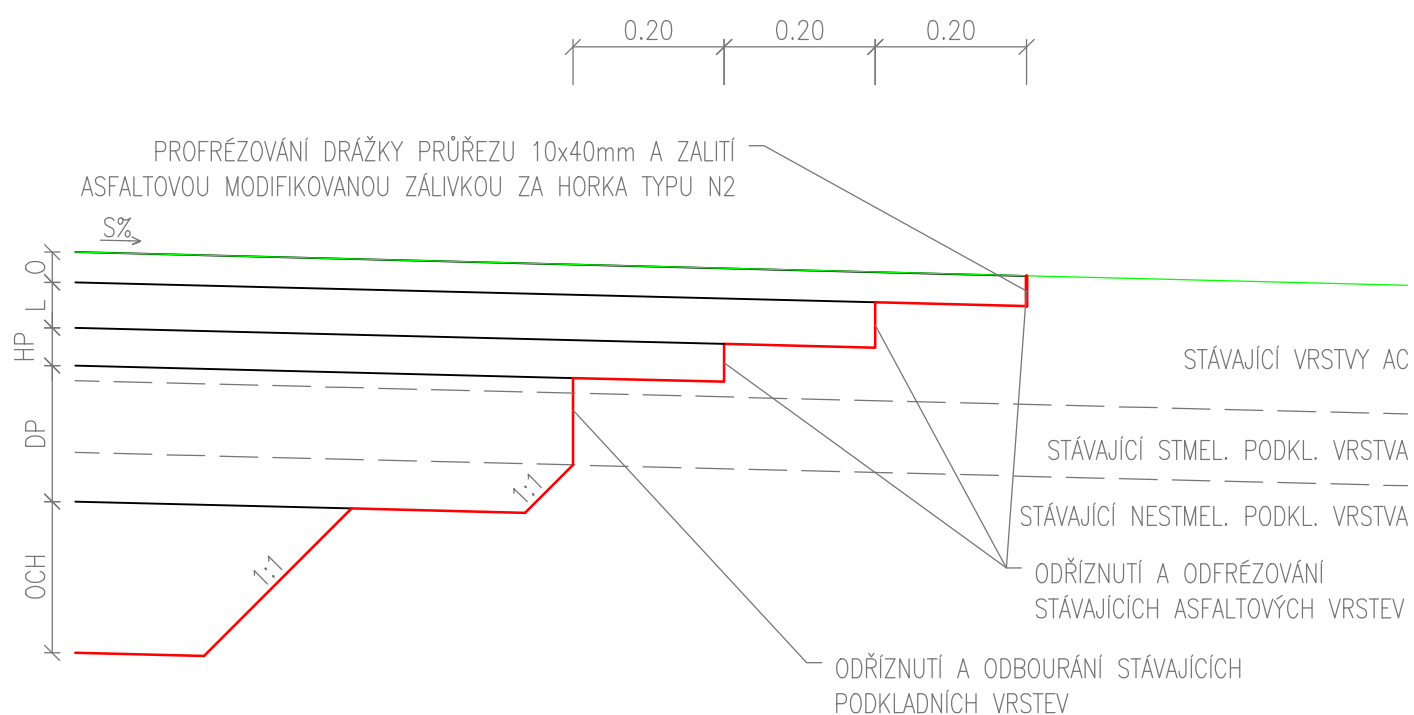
## DETAIL UKONČENÍ VRSTEV VOZOVKY 1:10
